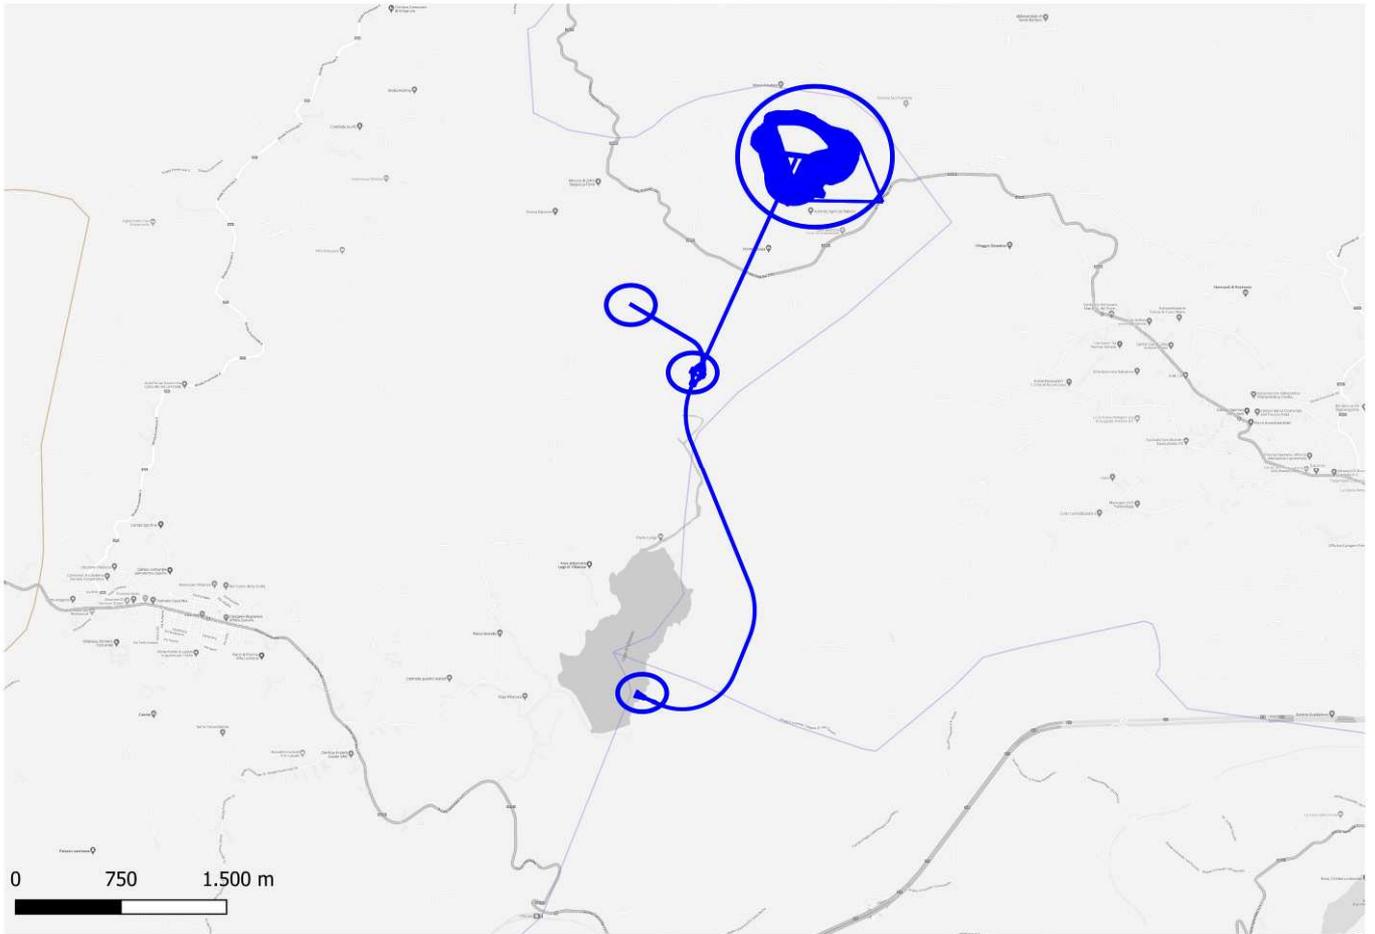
Planimetria intervento. Cerchiate in azzurro le aree di scavo a cielo aperto
